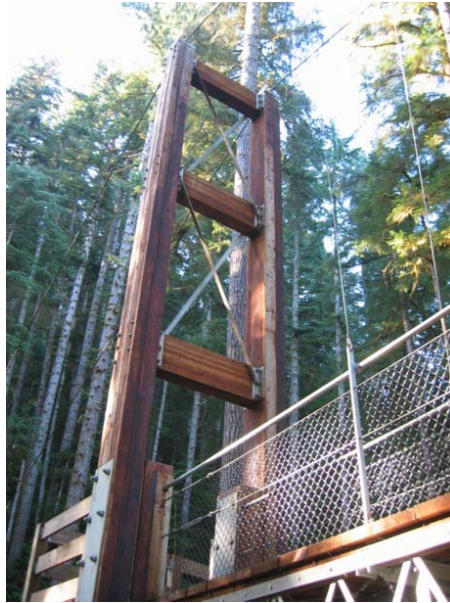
Detalle del diseño general de los pórticos en donde se puede observar el doble refuerzo de su base
